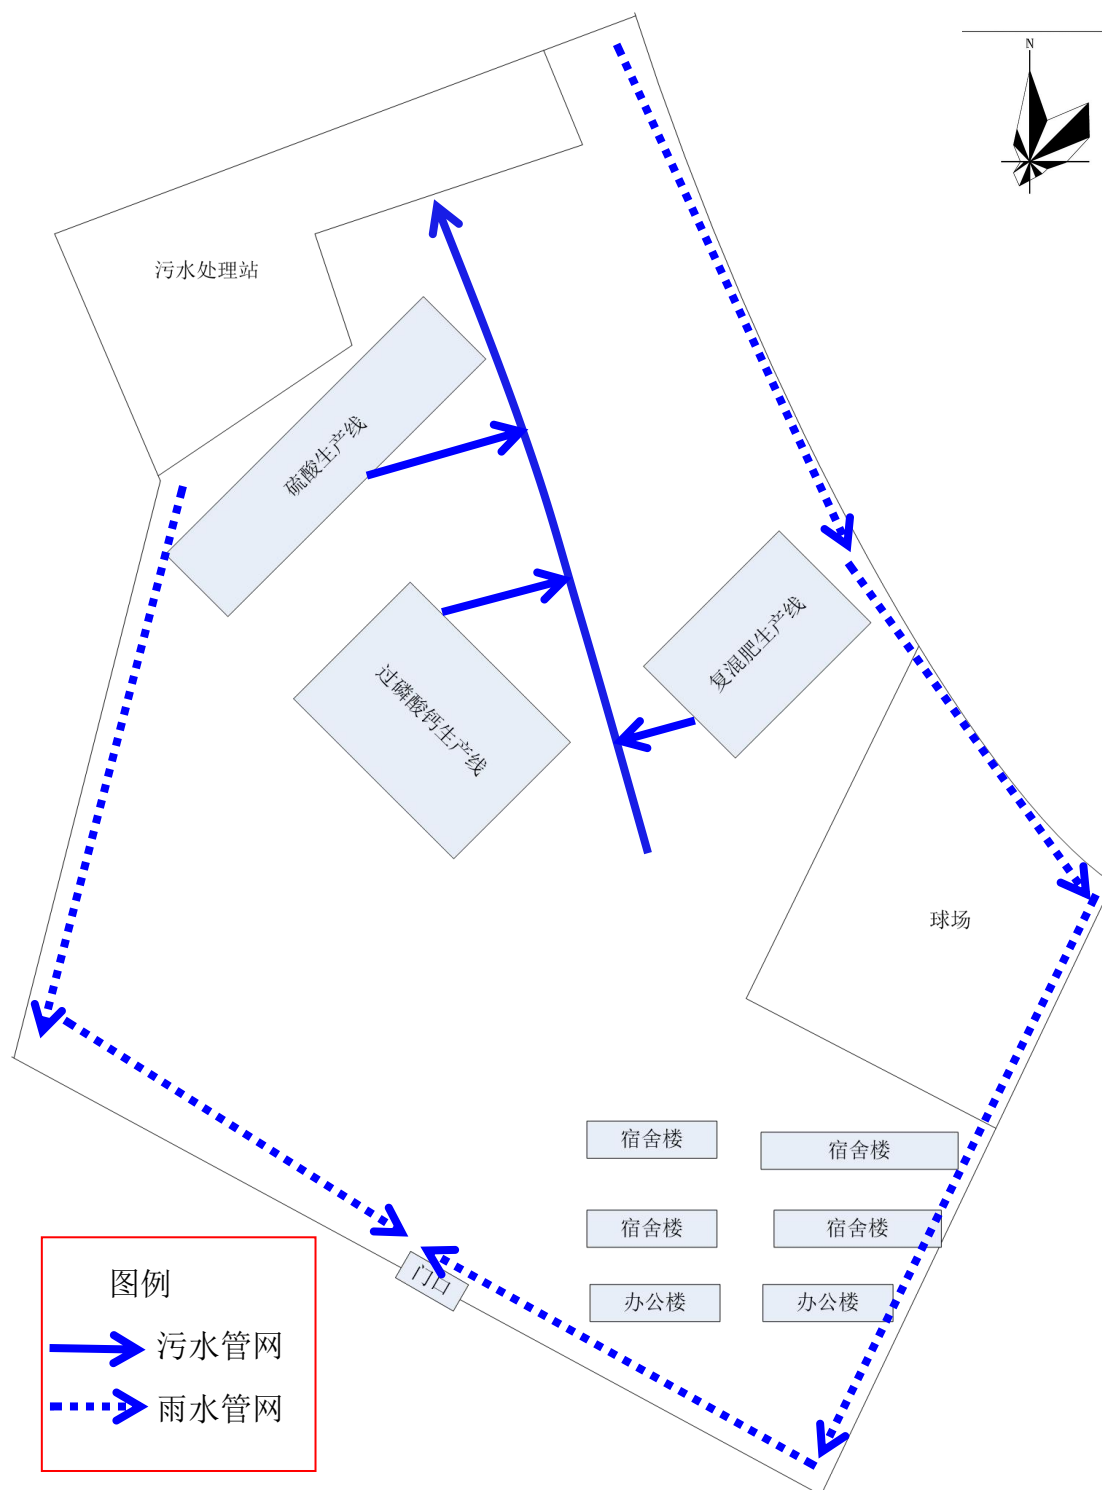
南风化肥厂平面布置图和污水管网布置图
